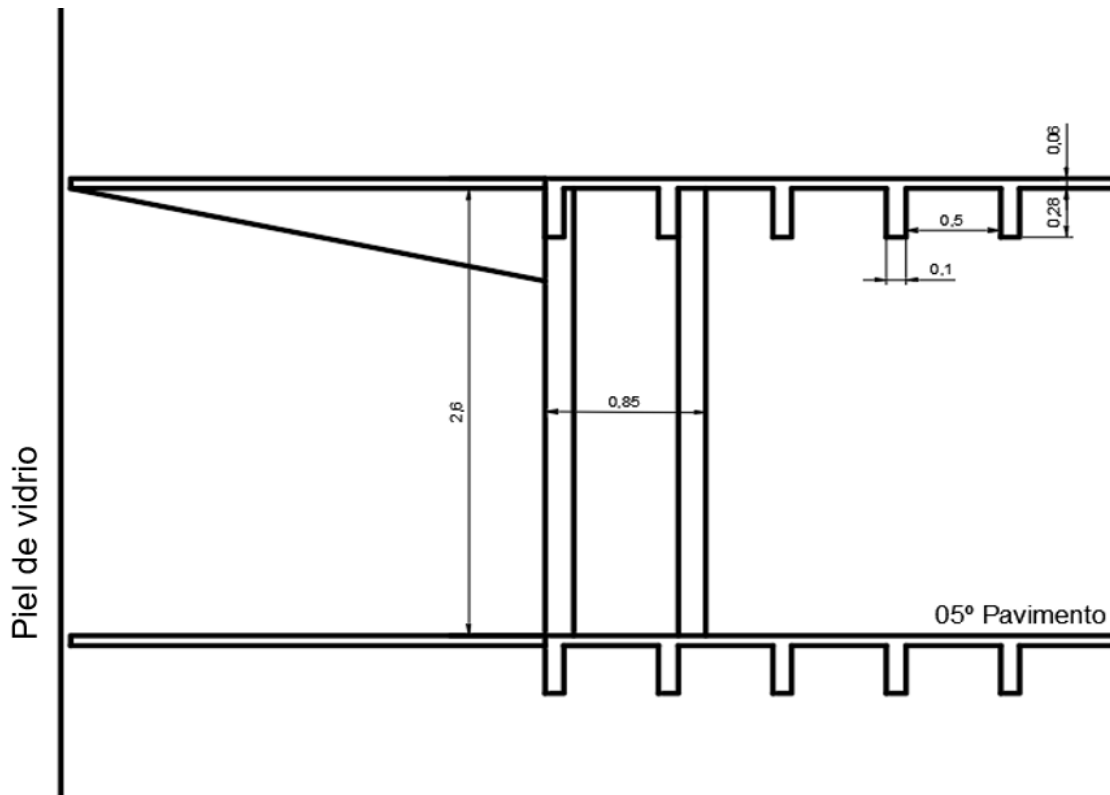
Corte de la losa nervada (Fuente: FAU-USP)
